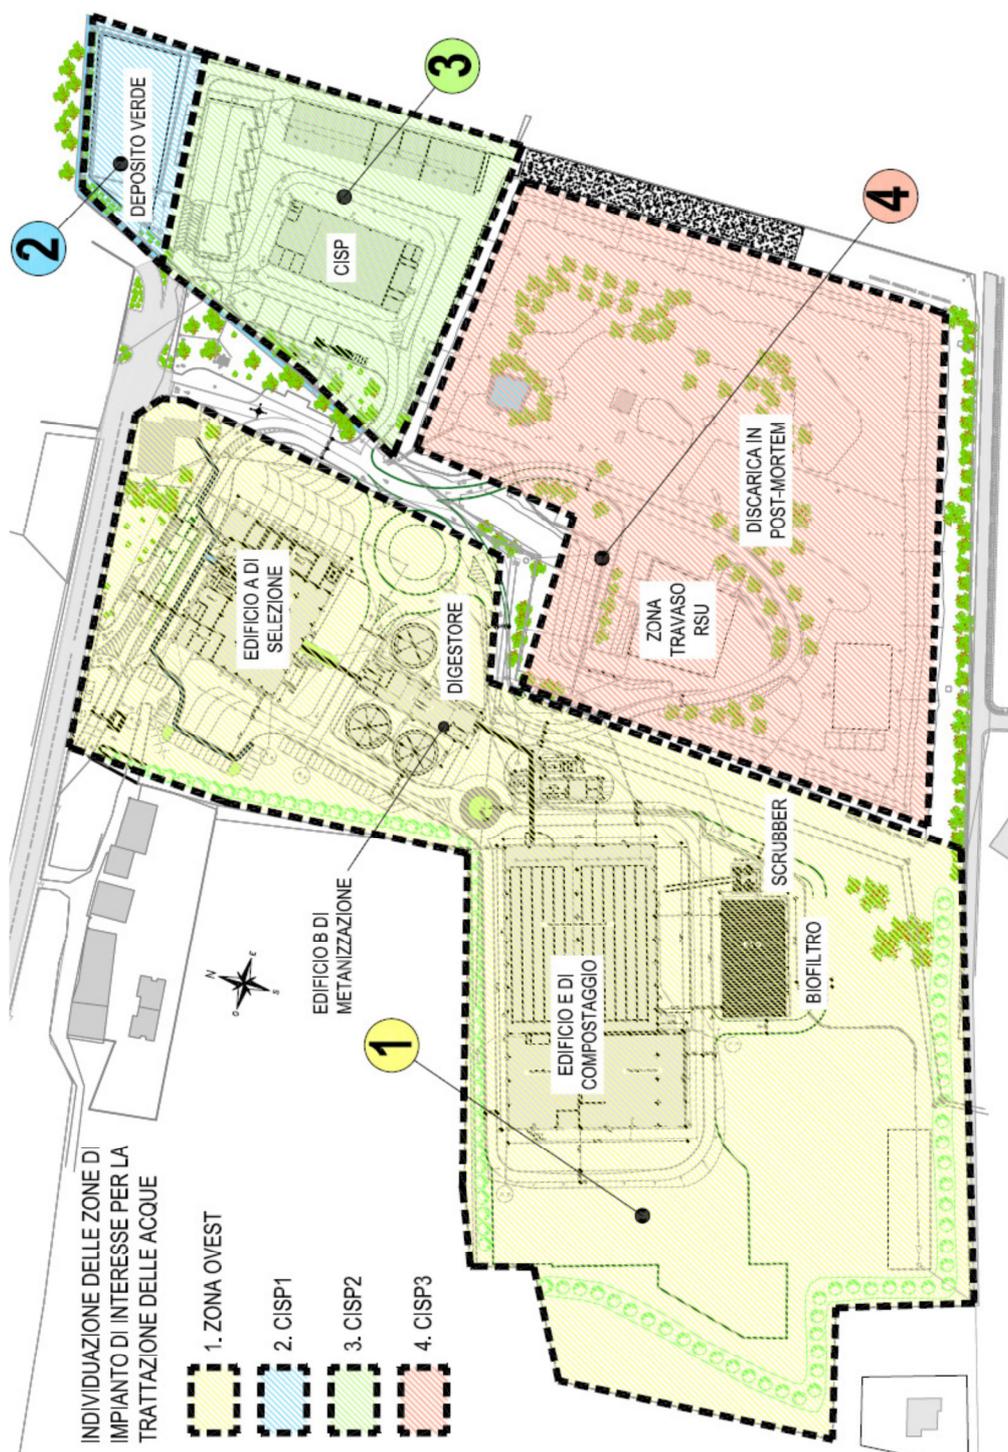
Suddivisione dell'area d'impianto nelle zone di specifico interesse.
